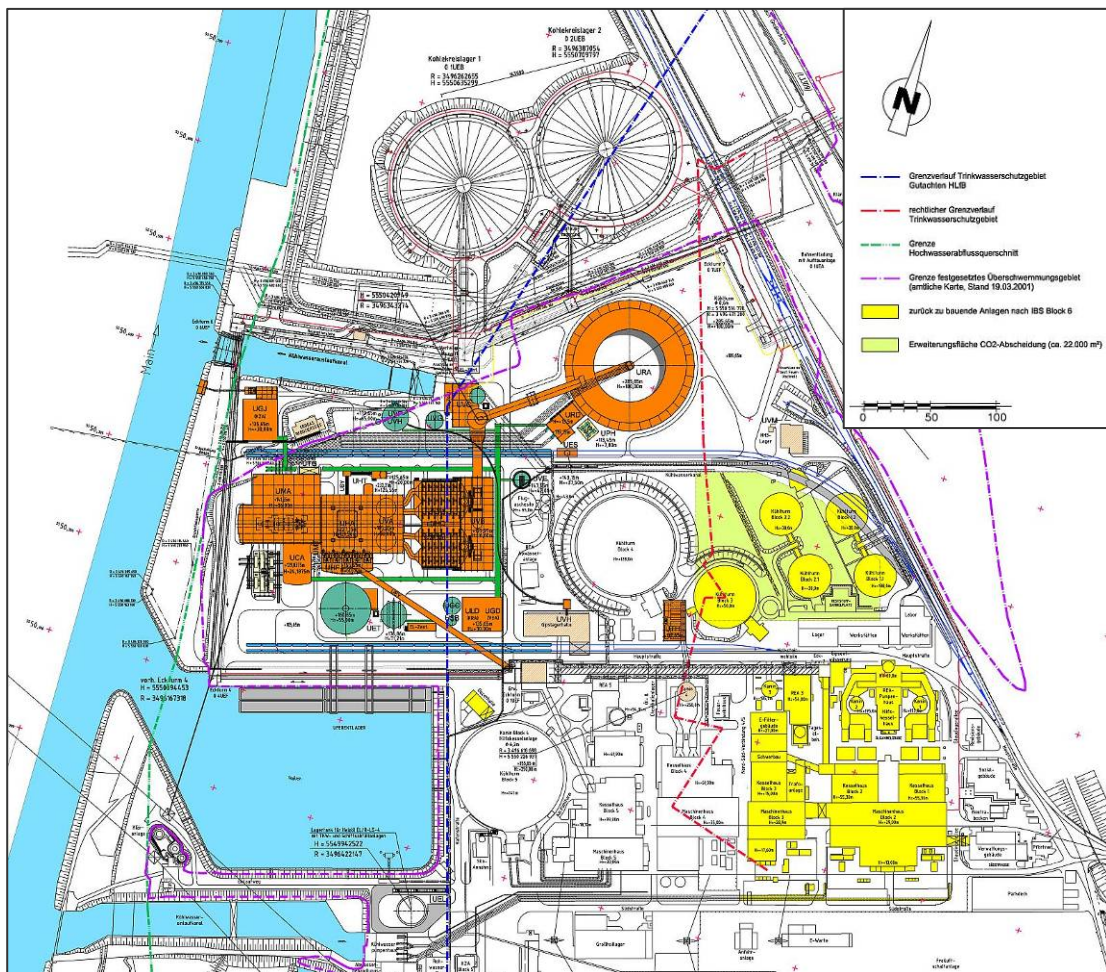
Lageplan Vorhaben 1100 MW Steinkohleblock
